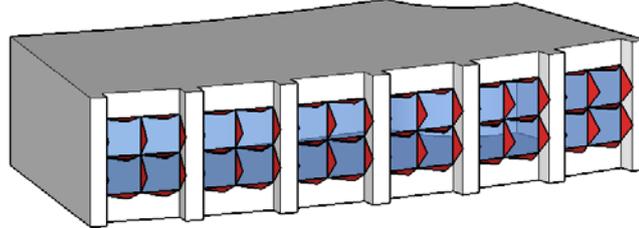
La façade avec dispositif d'ombrage ouvert à 60°
